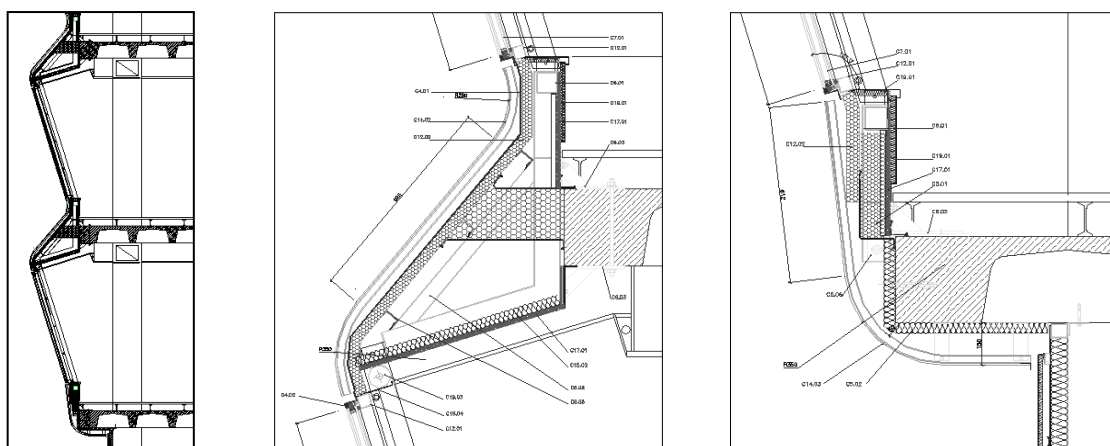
Detalles constructivos fachada edificio Génova Madrid (ver también apartado 3.8.4)
